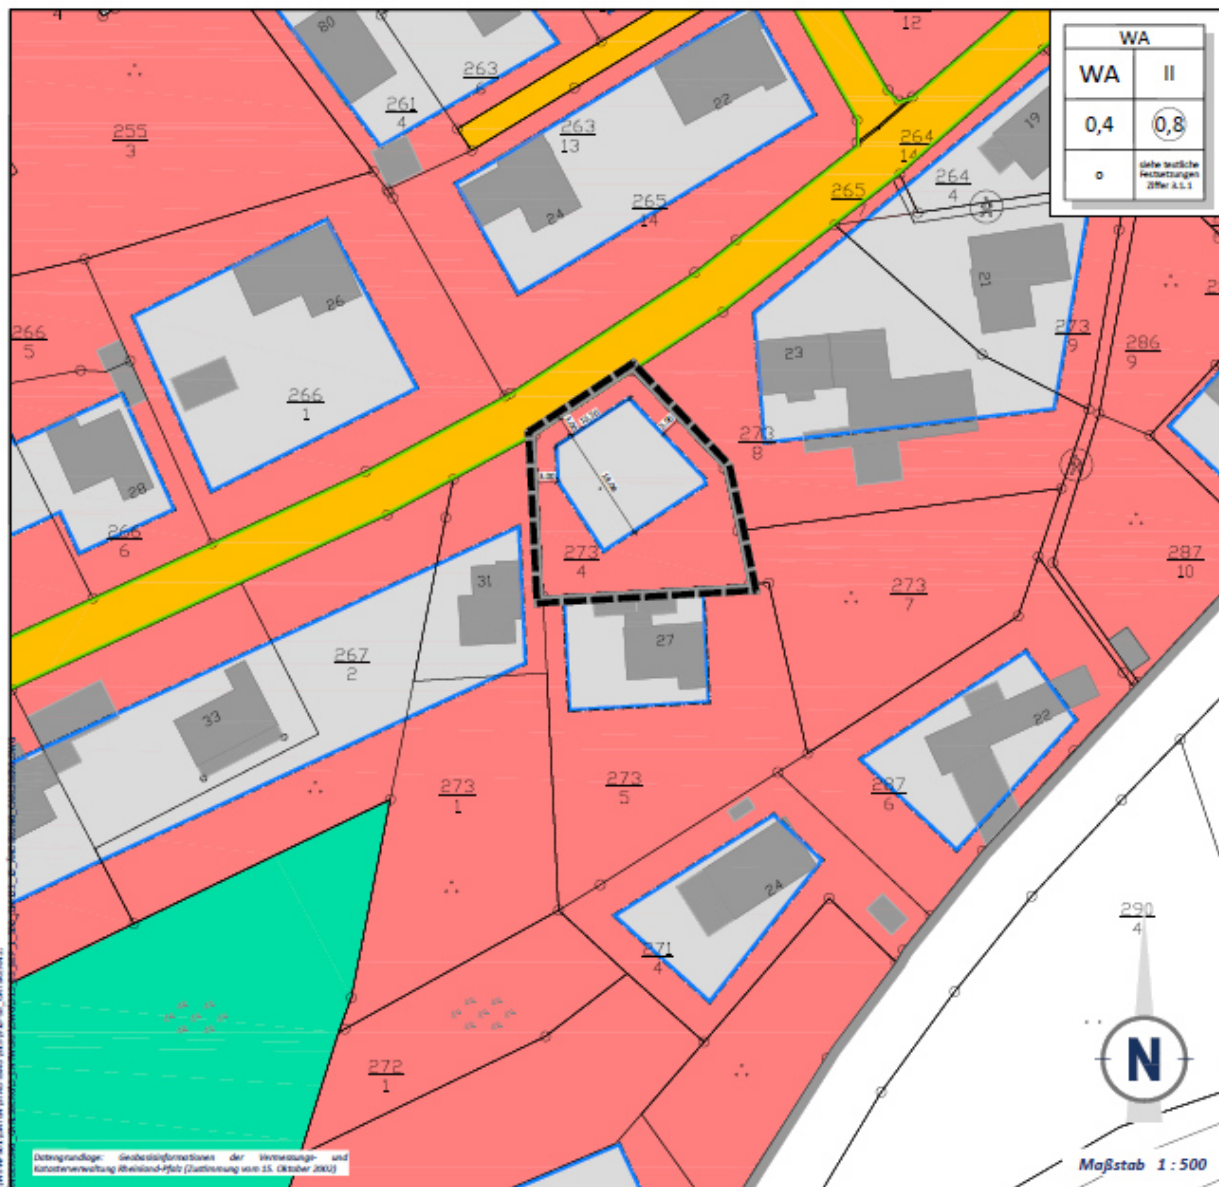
Bebauungsplan „Ortskern, 15. Änderung“
